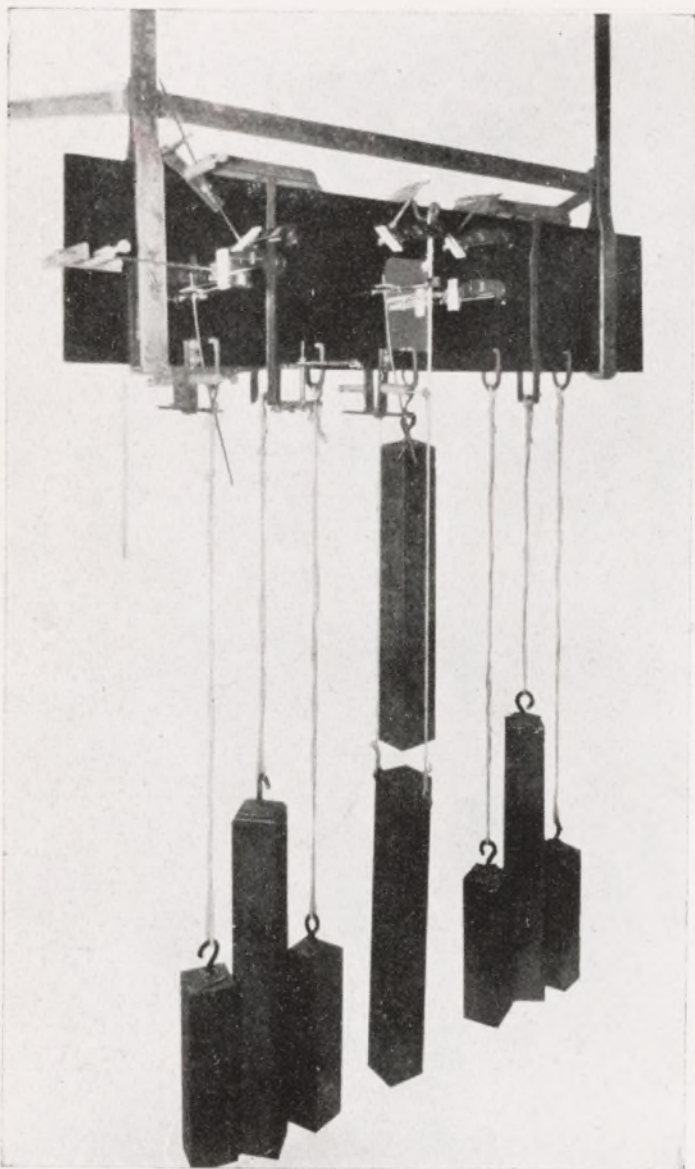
Essai sur modèle réduit d'une poutre en béton armé de 20 m. de portée à évidement central.
